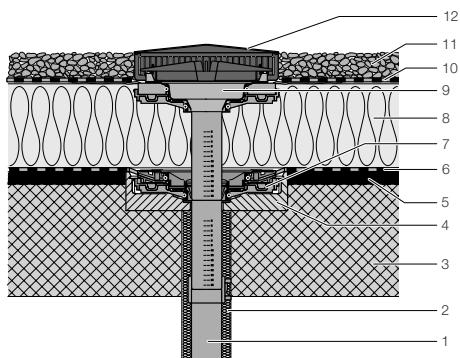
Конструкция монолитной кровли, изолированной, с кровельным покрытием и креплением пароизоляции
